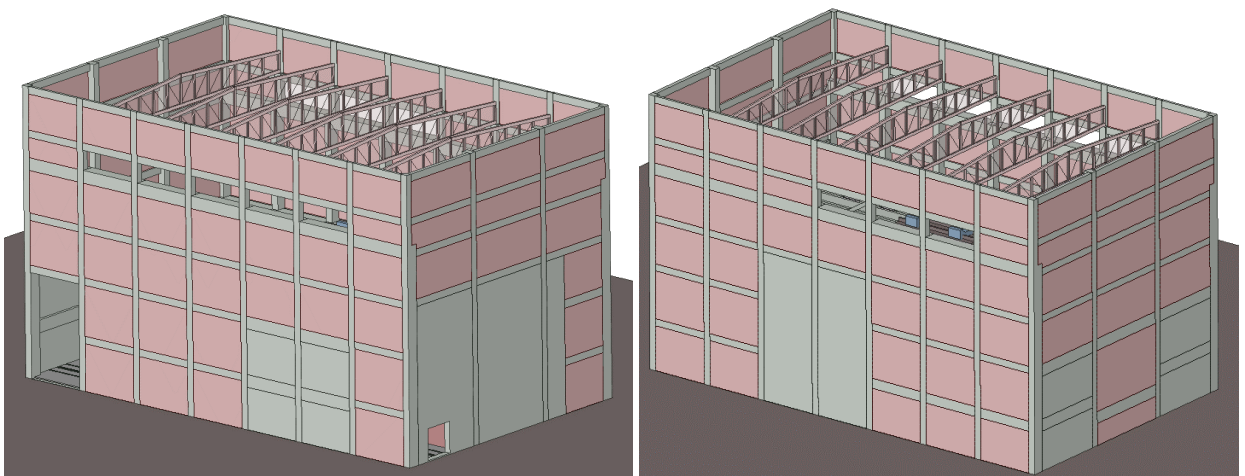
Cerramientos exteriores de fábrica de ladrillo (rojo pálido) y muros de hormigón (gris)
